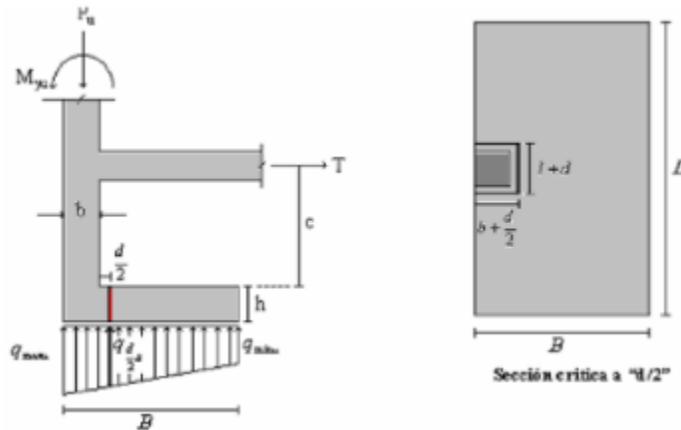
Sección crítica a punzonamiento para zapata medianera
